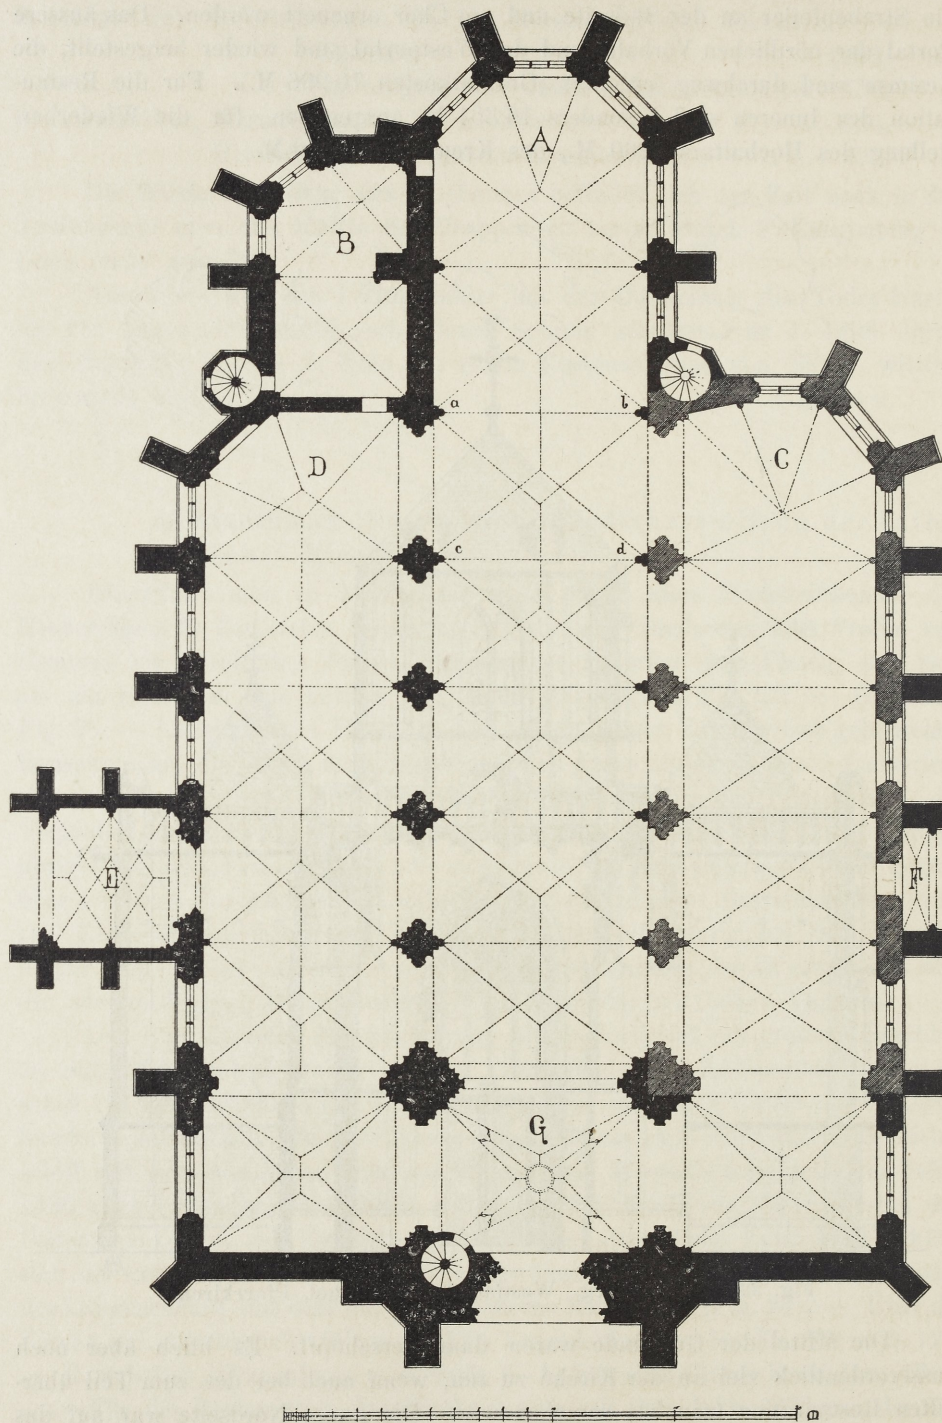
, Kranenburg. Grundriss der kathol. Pfarrkirche.
